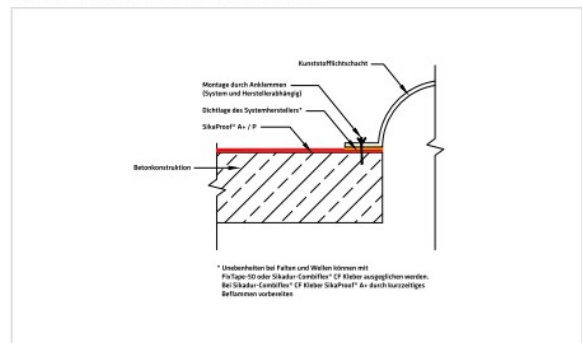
Anschluss an Bestand mit Klemmkonstruktion
